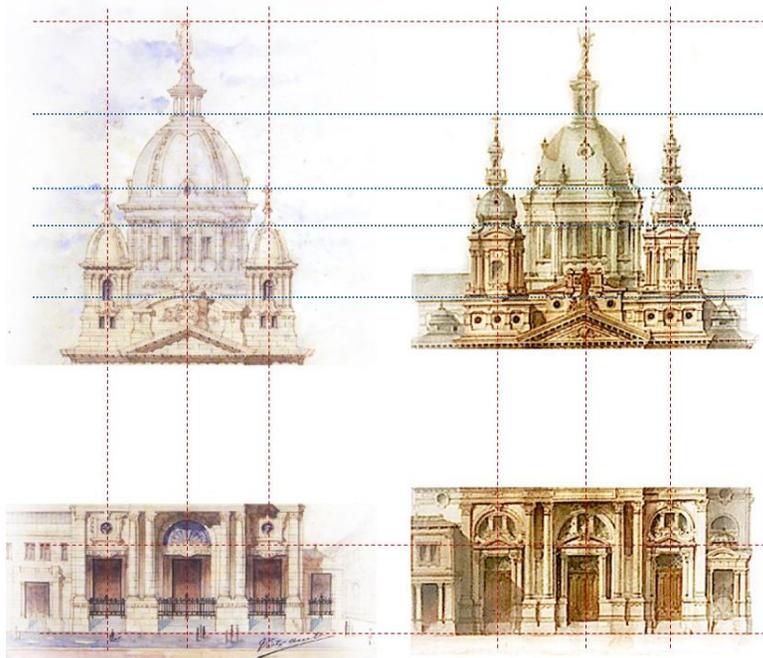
Elaboración propia. comparación de dimensiones de las fachadas propuestas por Auclair y Provasoli respectivamente.
